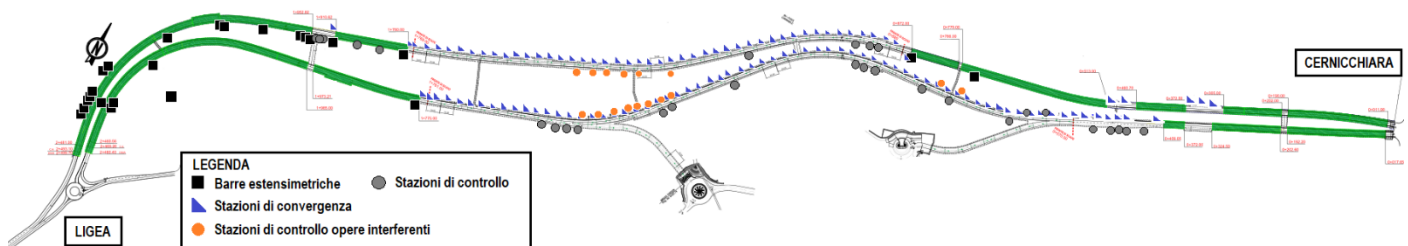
Planimetria dell'opera e delle stazioni di monitoraggio.
